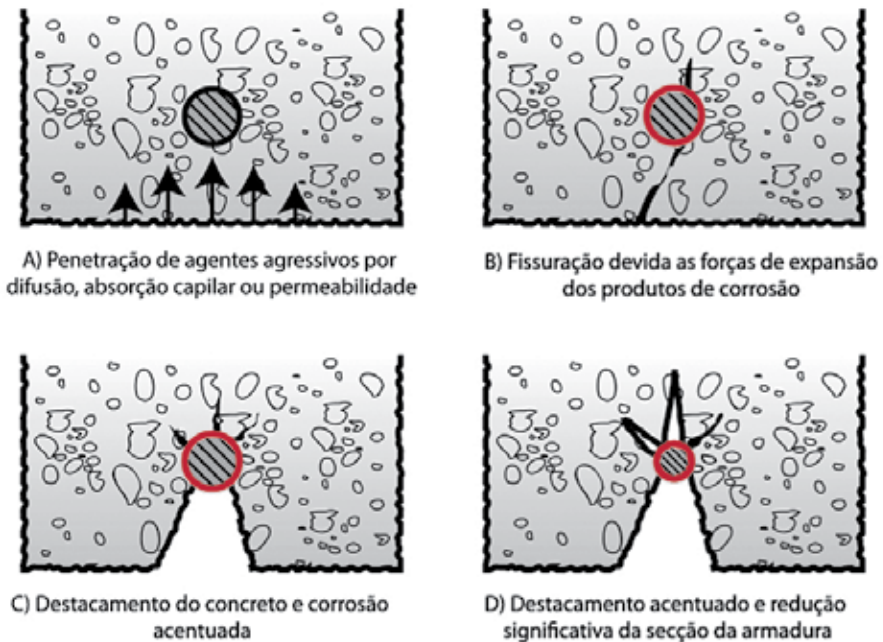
Evolução esquemática da deterioração de estruturas de concreto por corrosão de armaduras (HELENE,1986).
